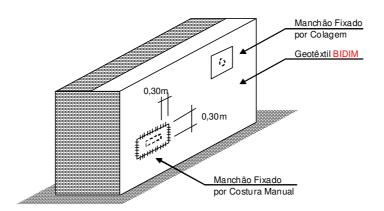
Desenho esquemático do manchão de geotêxtil Bidim sobre a manta instalada (em caso de rasgos ou furos durante a instalação).
